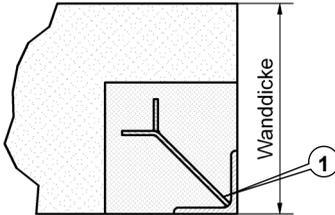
Maueranker in der Wand eingemörtelt (Mauerwerk- und Betonwand)
